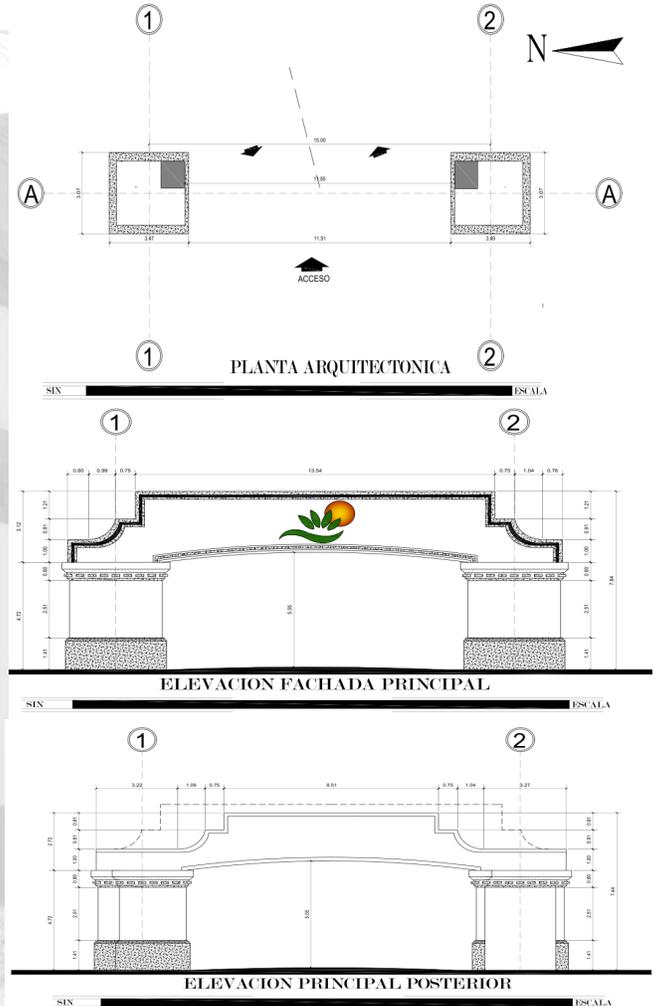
Planta y Elev.Arq./Fuente:Roberto López
